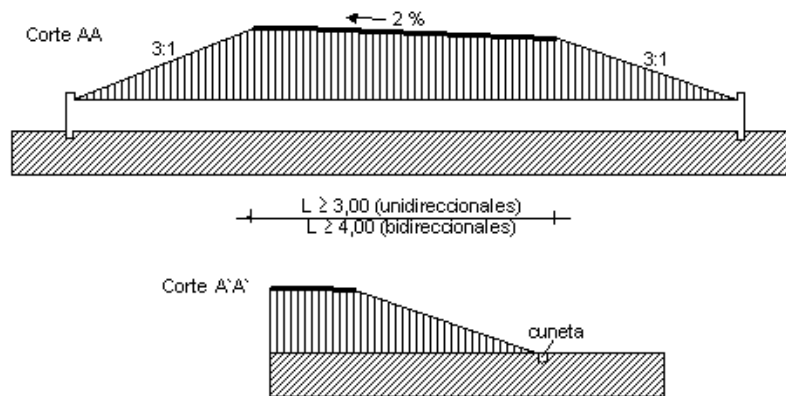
DRENAJE EN TERRAPLENES.
